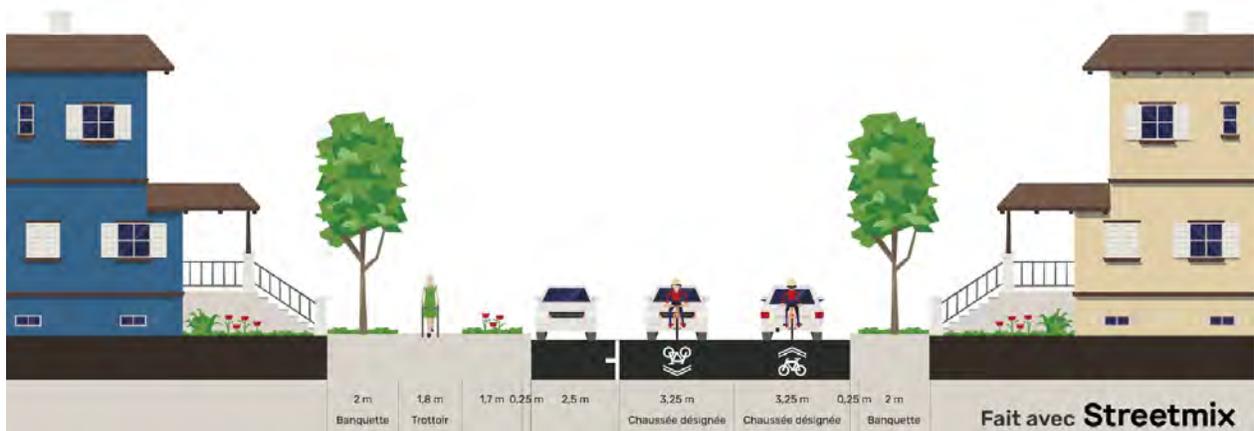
Coupe LR-04 : rue avec chaussée de 9,0 m, trottoir et banquette
